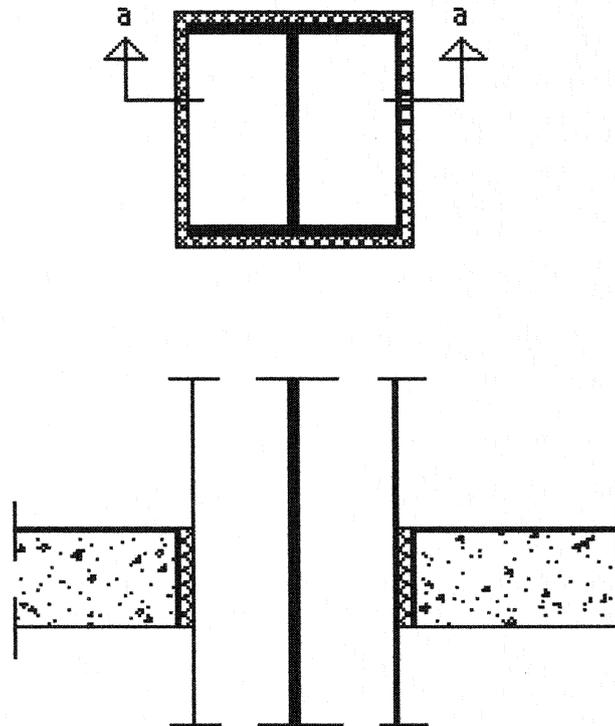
d: Avfuging mot H-profil stålsøyle, plan og oppriss.
